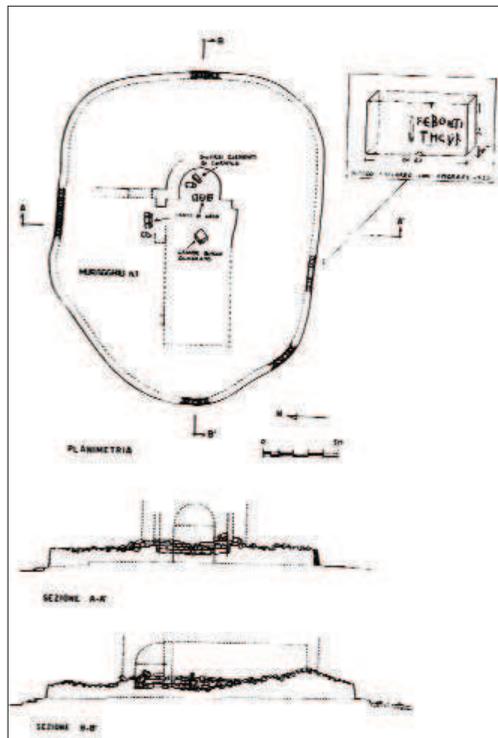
Cava Prainito, Cozzo Tondo. Planimetria dei resti della chiesa inglobati nel "muragghiu"
